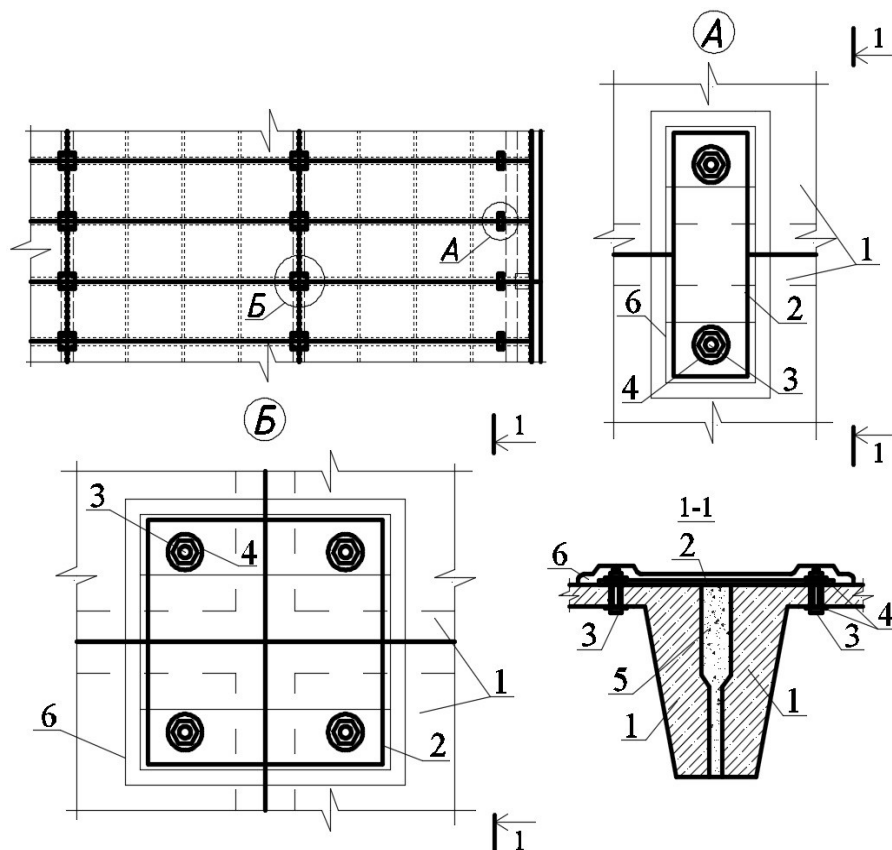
Устройство жесткого диска покрытия: 1 – железобетонные ребристые плиты покрытия; 2 – накладки из стальной пластины 400×400 мм толщиной 12 мм; 3 – стяжные болты Ø 20 мм; 4 – шайбы диаметром 60 мм; 5 – бетон замоноличивания швов класса В15; 6 – цементно-песчаный раствор или антикоррозийное покрытие
